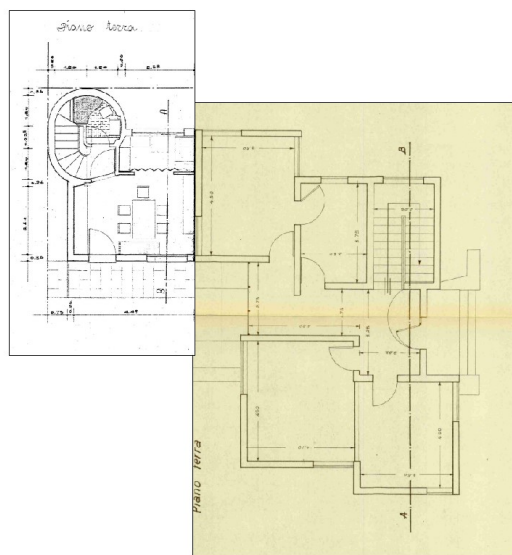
affiancamento del progetto originario con il progetto dell'ampliamento – piano terra
